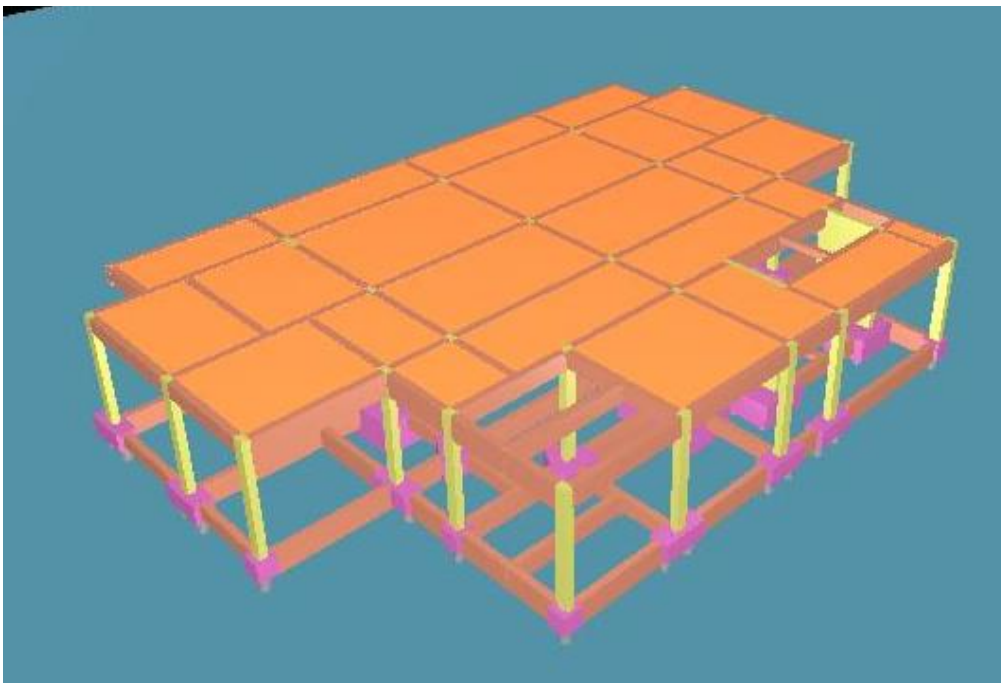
Forma da Fundação Até o Primeiro Pavimento
